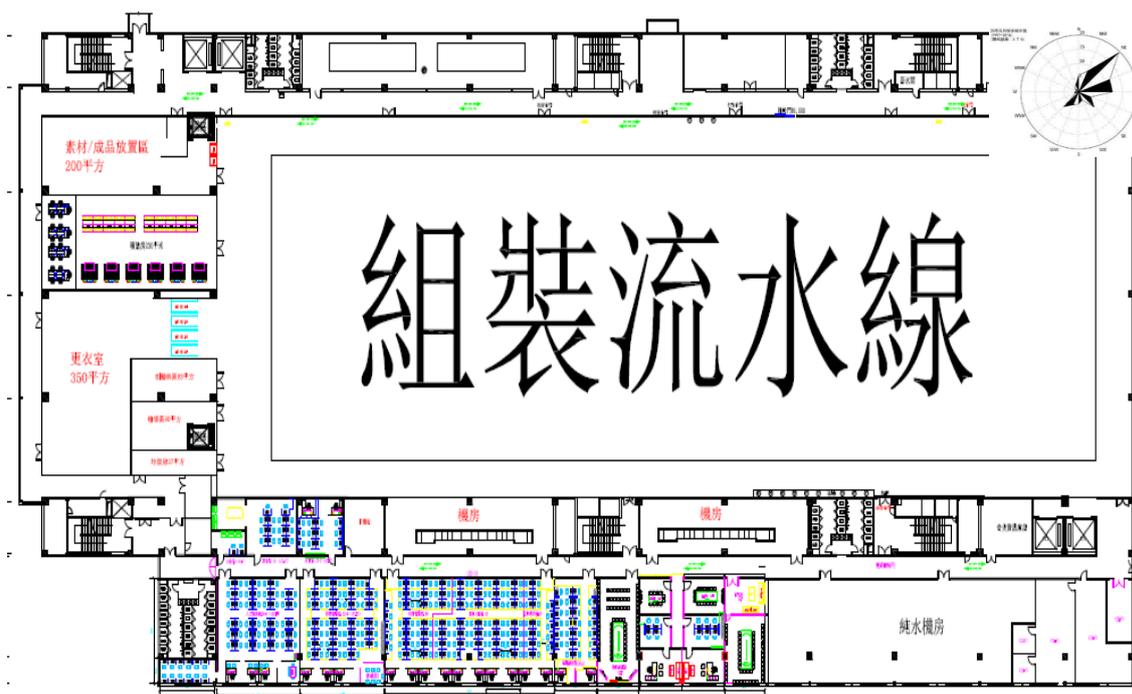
项目G2区厂房1栋2层A区车间平面布置图
